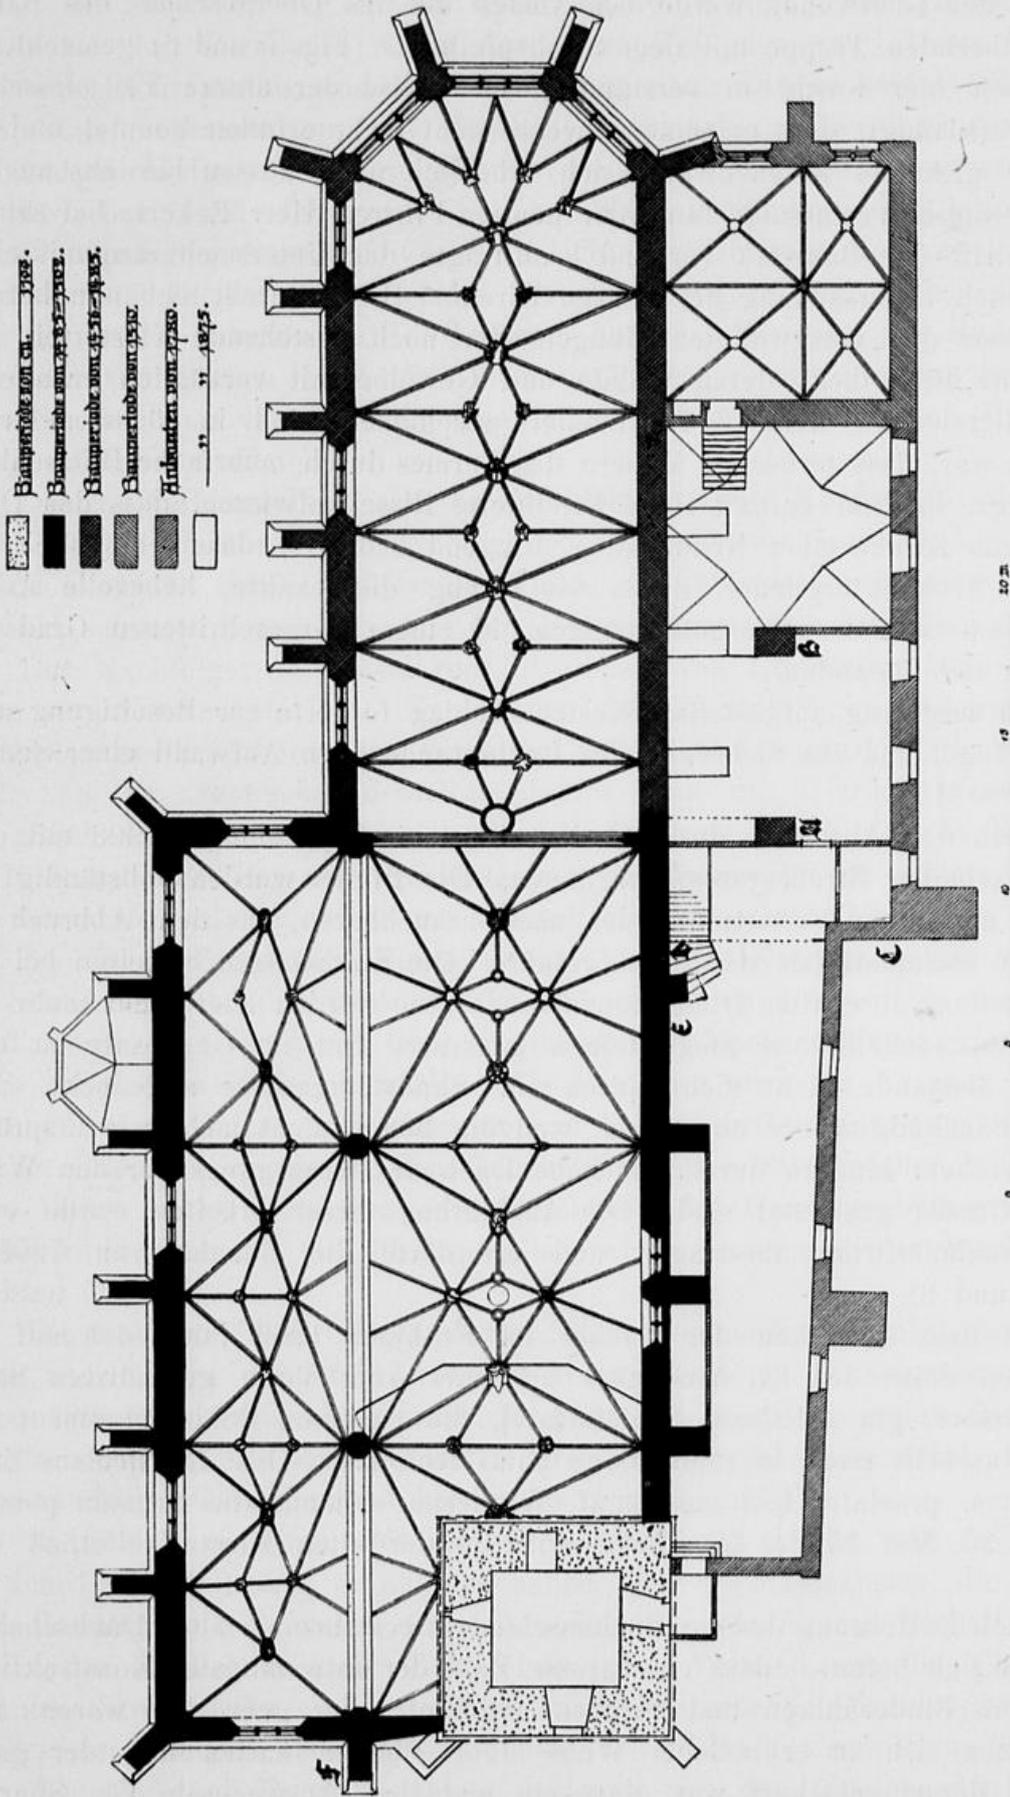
Clausen. Wallfahrtskirche. Oberer Grundriss vor der Wiederherstellung.
